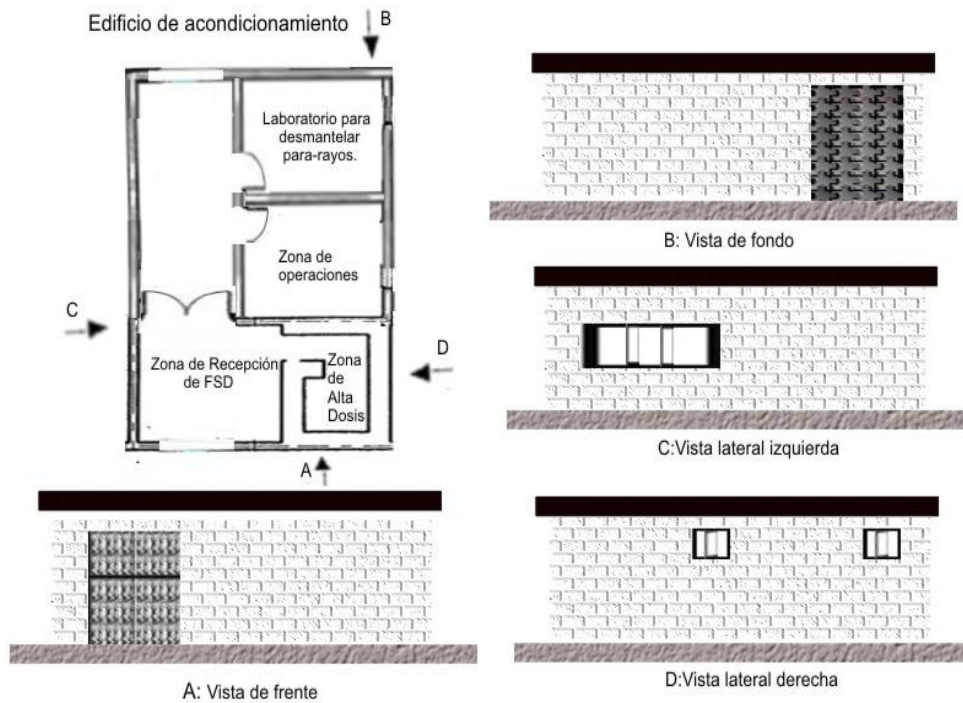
Fachadas de la Edificación de Acondicionamiento
